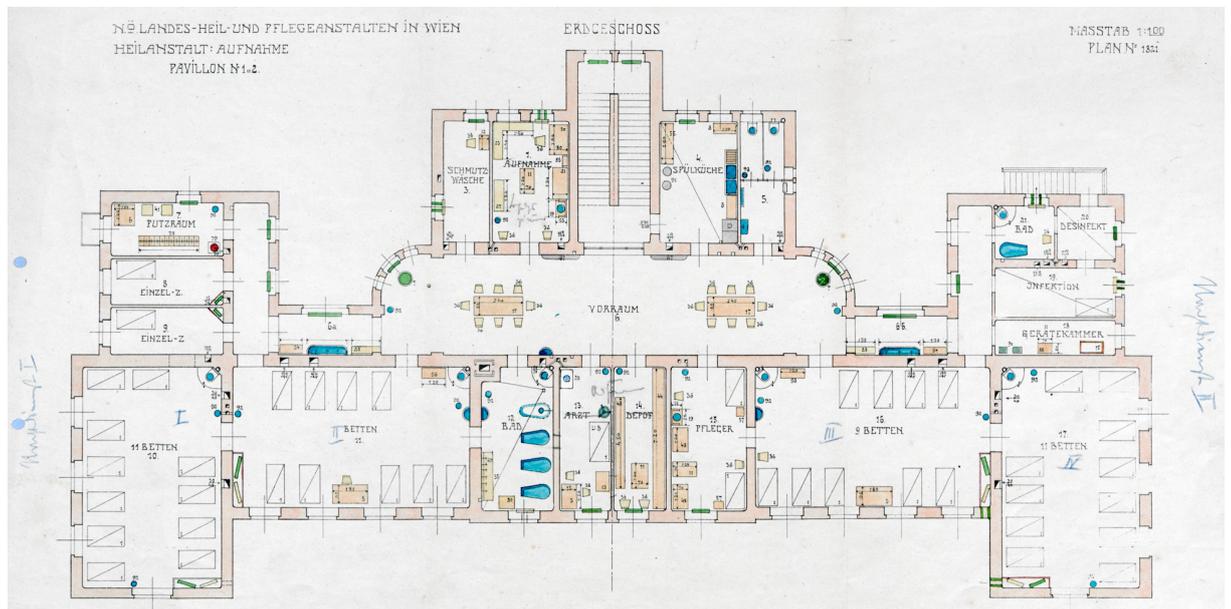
Grundriss Pavillon 1 und 2 von 1821
